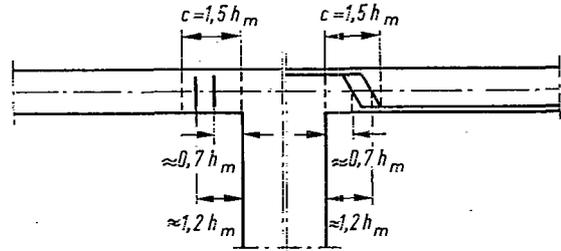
Pilzdecke ohne Stützenkopfverstärkung bei Durchstanzgefahr (Beispiel für Schubbewehrung)
